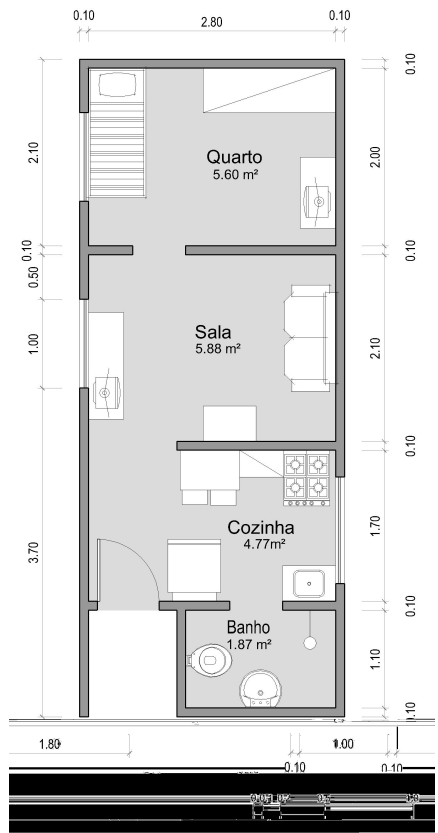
Planta baixa da sala com 18,1 m<sup>2</sup>.
